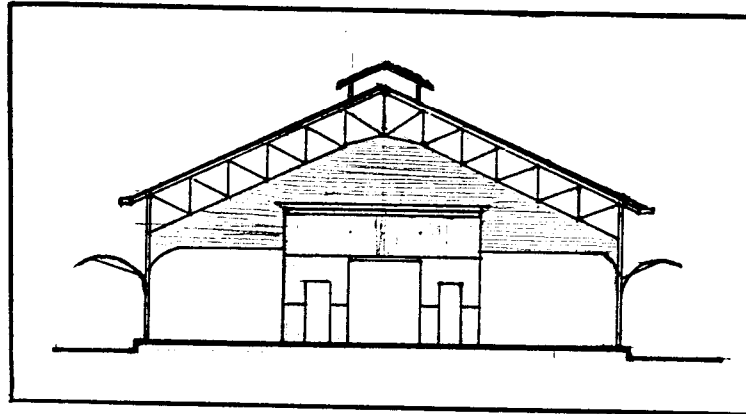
Penataan ruang dan bangunan MKAA.
